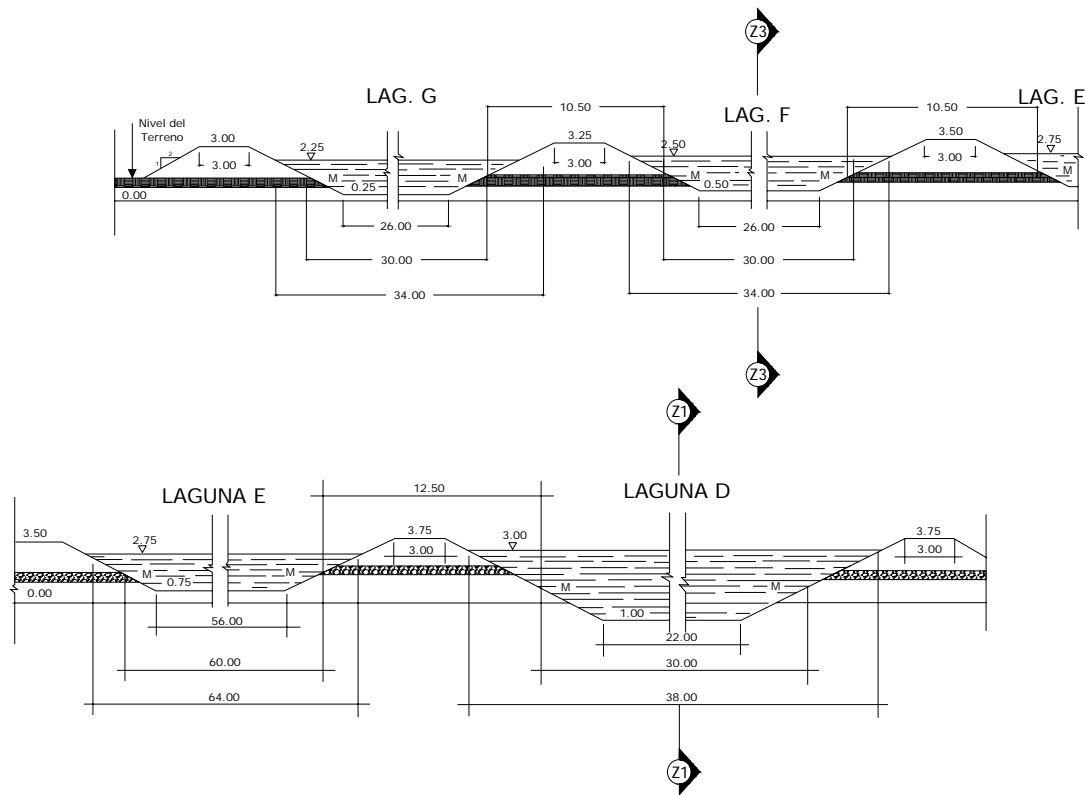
Perfil de los diques y de las lagunas sobre el eje Y-Y de la figura 5.3.1.5.
